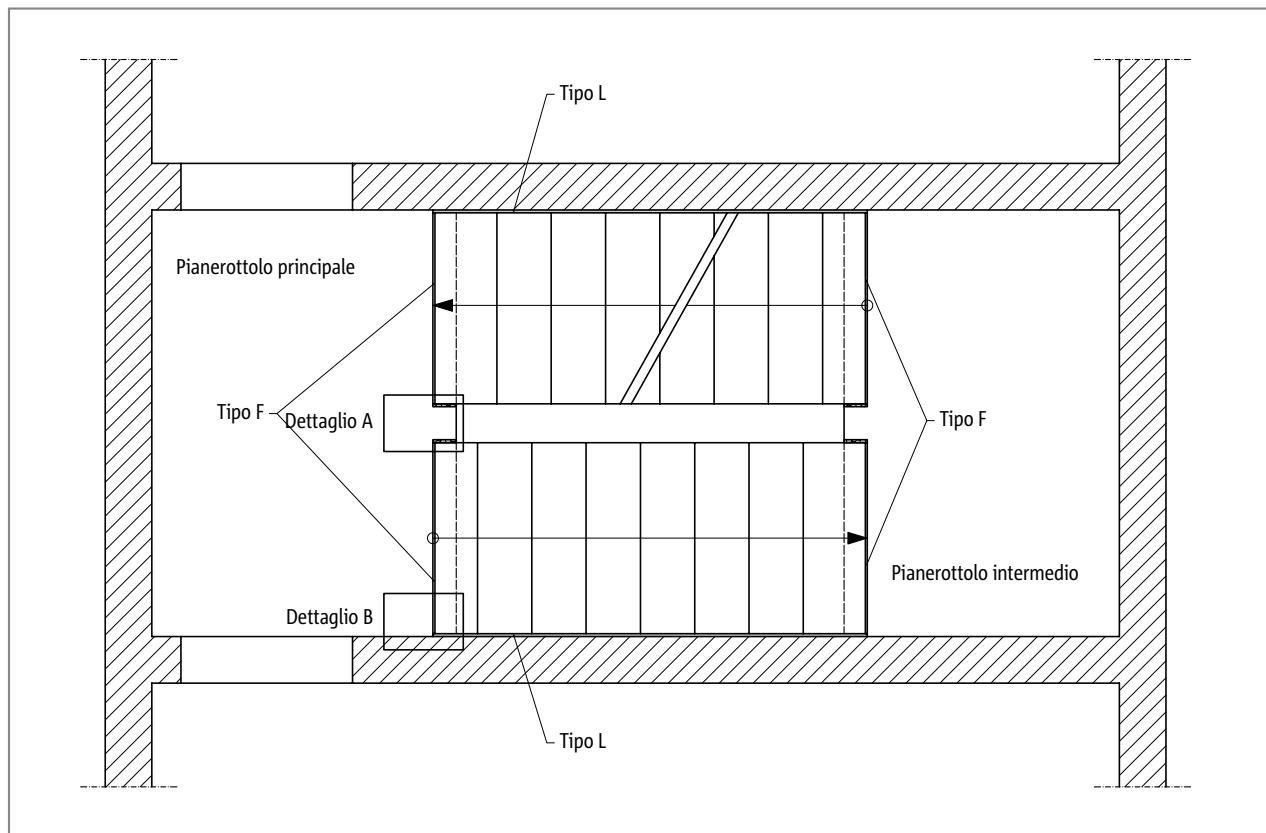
Schöck Tronsole® tipo F, disposizione dell'elemento in pianta
